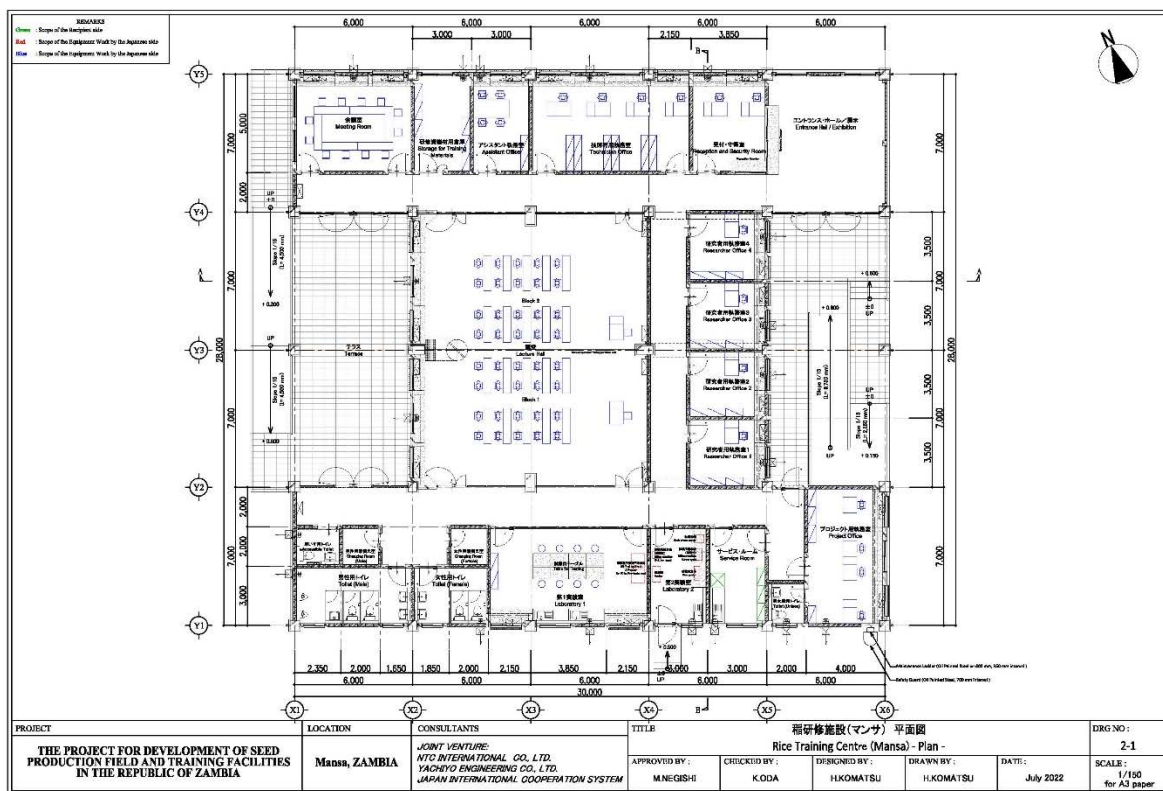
稲研修施設の平面図(マンサ研究所)
